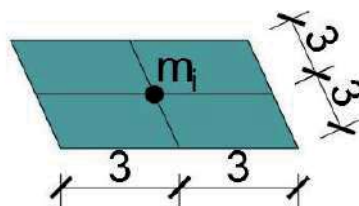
Элементарный квадрат плиты перекрытия
